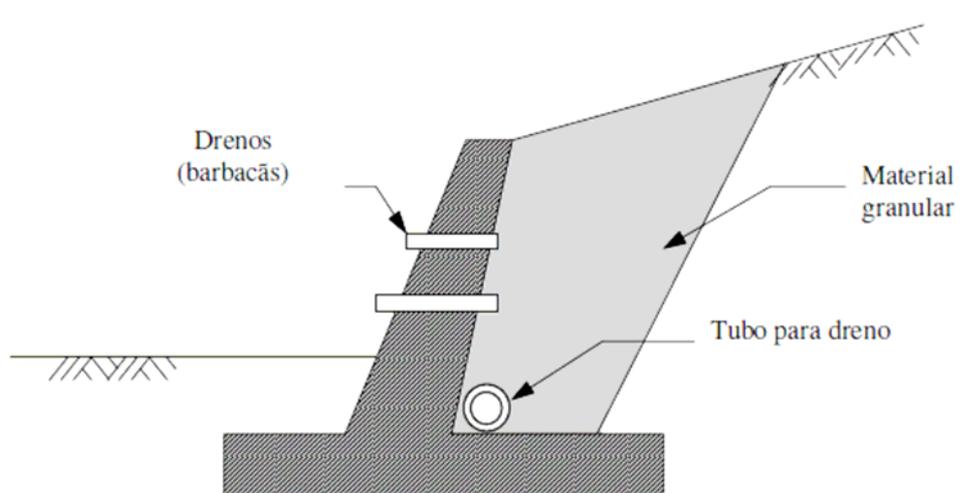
Exemplo de sistema de drenagem em muro de arrimo
